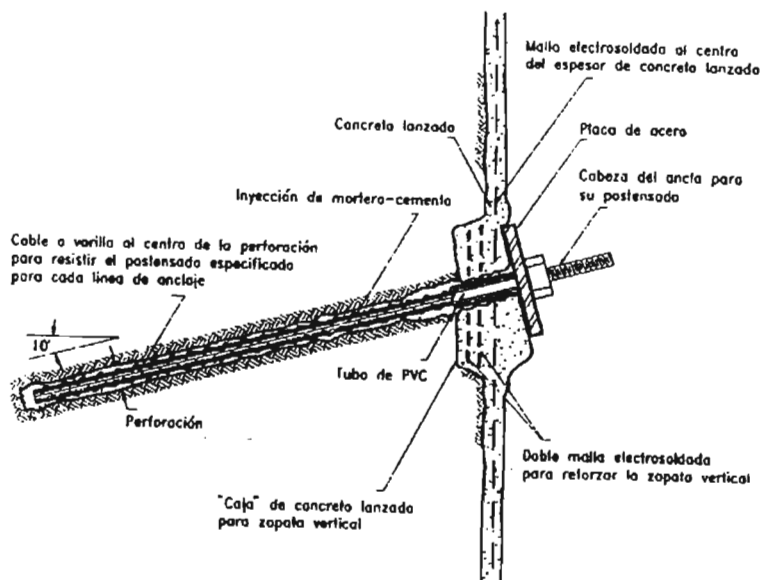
Anclaje reforzado con concreto lanzado y malla electrosoldada.
